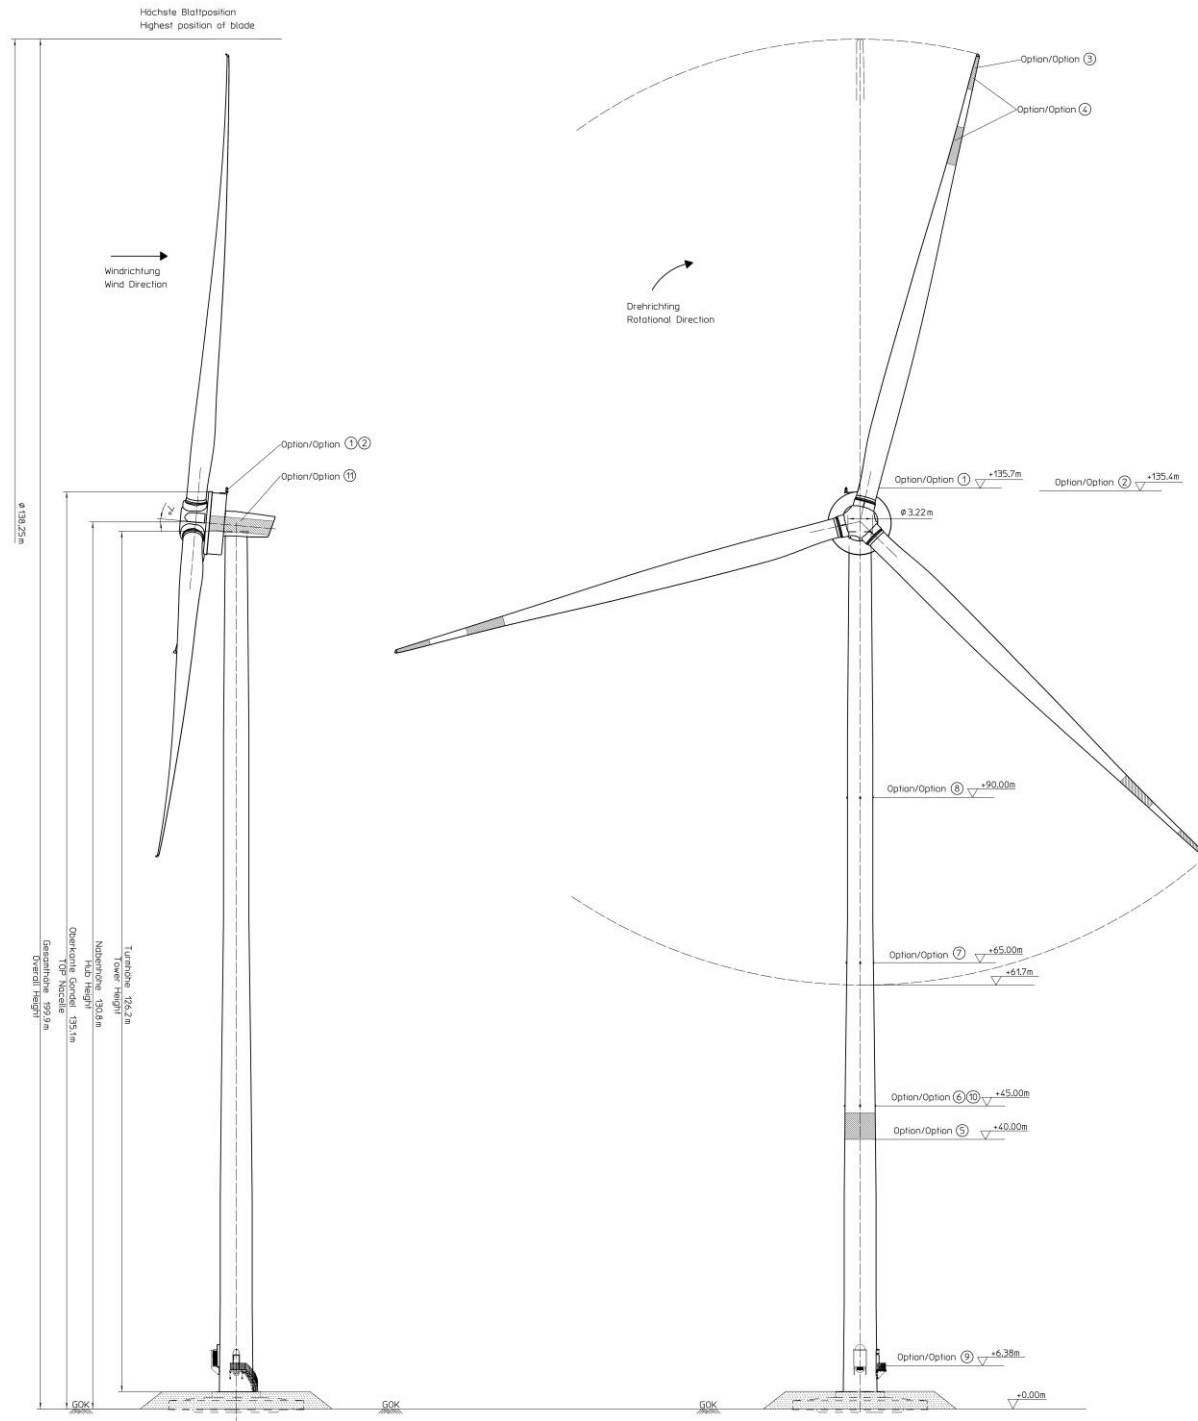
Plans de façade de l'éolienne E-138 (Source : Enercon)
